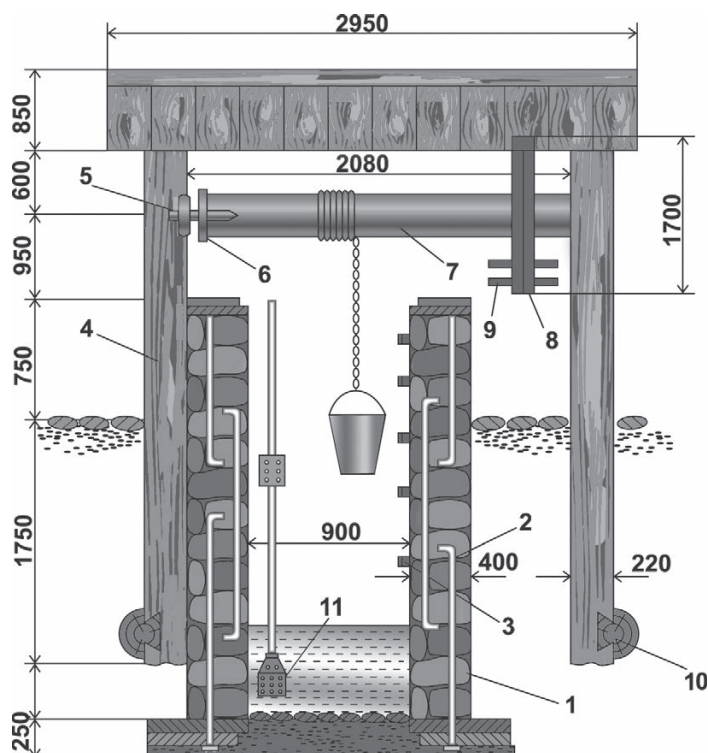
Схема кирпичного колодца (мм): 1 — кладка; 2 — анкер; 3 — скоба; 4 — стойка диаметром 22 см; 5 — арматурный стержень диаметром 3 см и длиной 31 см; 6 — диск диаметром 30 см и длиной 31 см; 7 — ворот-бревно; 8 — колесо; 9 — деревянная рукоятка; 10 — деревянная опора; 11 — вибрационный насос
